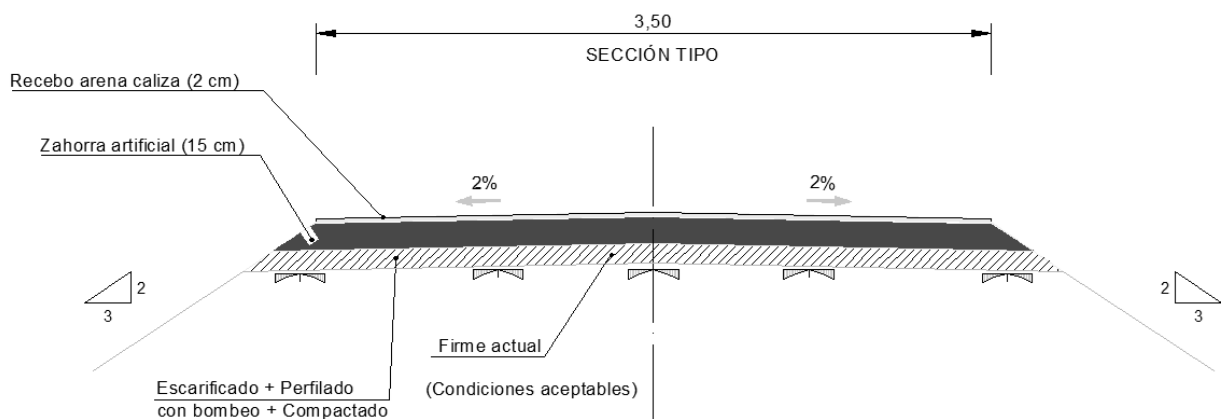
Sección tipo sobre camino existente. Fuente: Elaboración propia.
